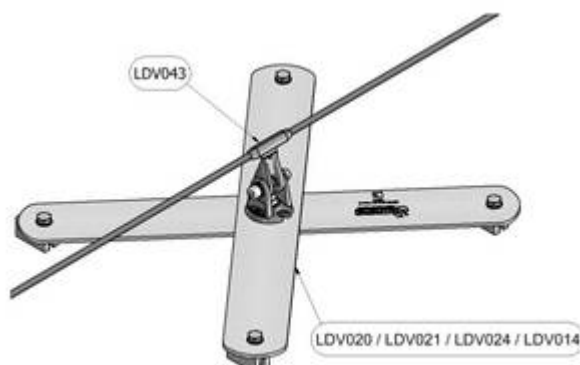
Montage ancre intermédiaire sur toiture à joints debout
